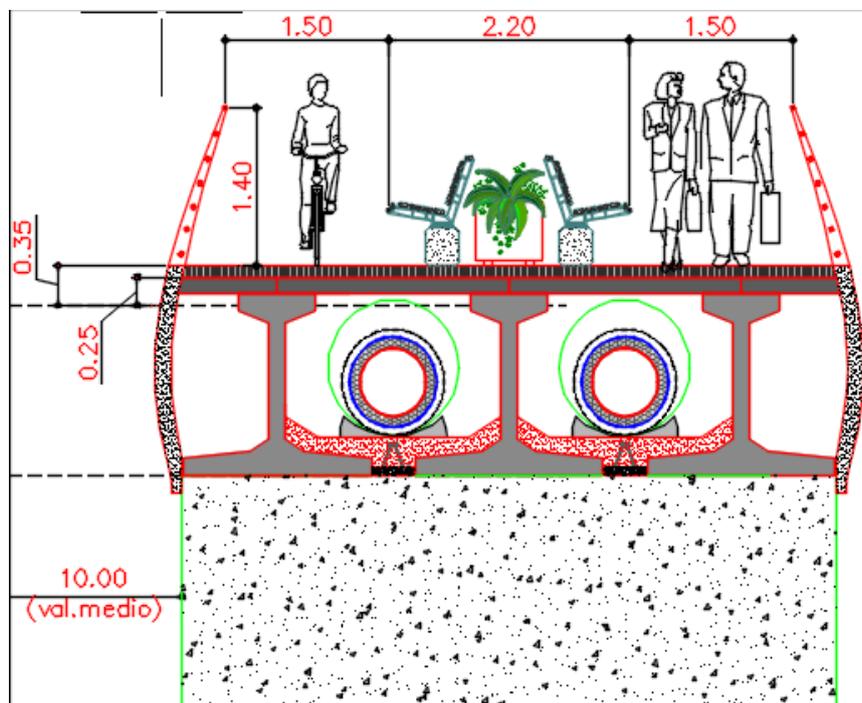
Sezione trasversale dell'impalcato ciclopedonale per l'attraversamento delle Tubazioni DN600 del teleriscaldamento del trincerone ferroviario.
